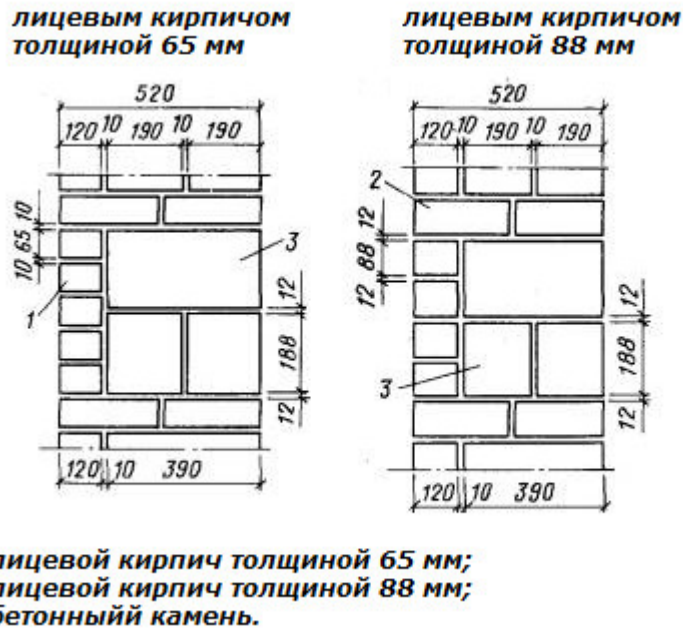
Облицовка лицевым кирпичом стен из бетонных камней
